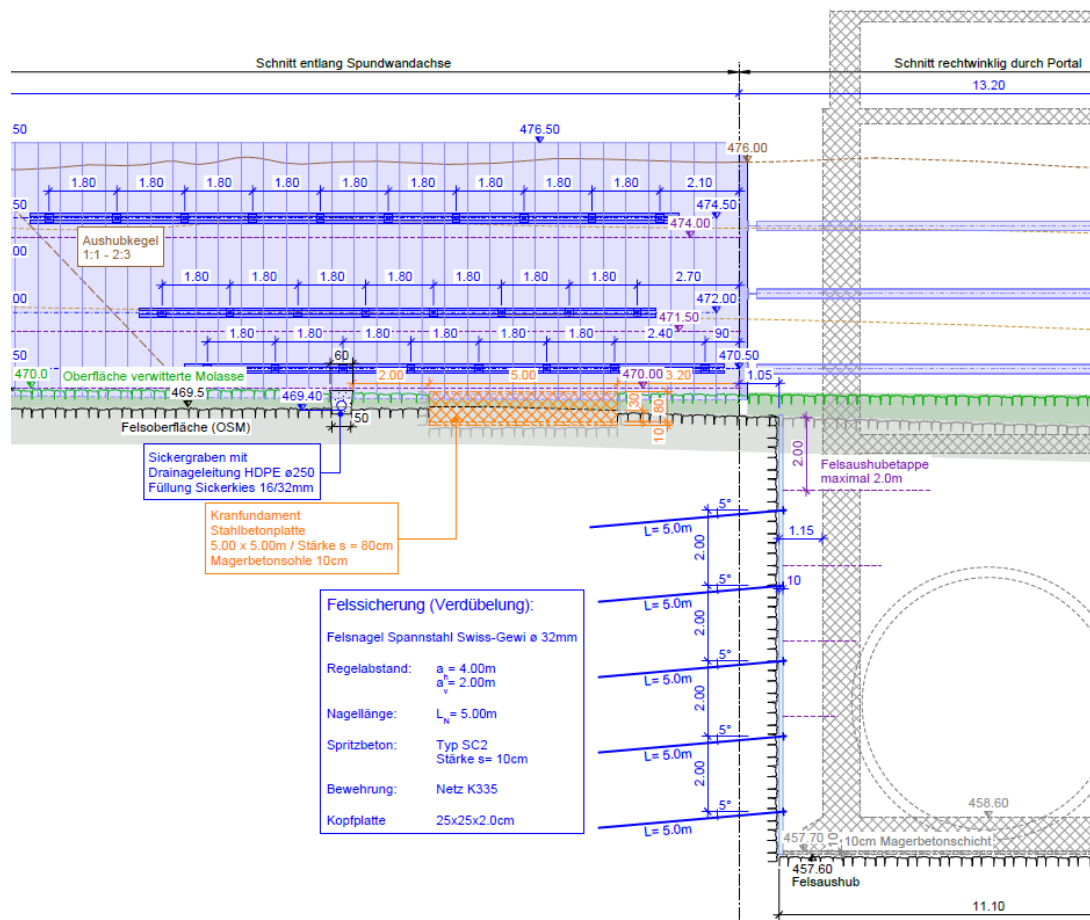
Schnitzauszug Standort Kranfundament, nördlicher Portalbereich
